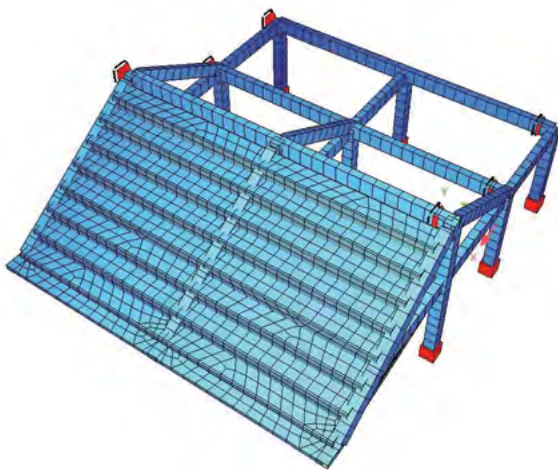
Modelo estructural del graderío, con SOFISTIK.
